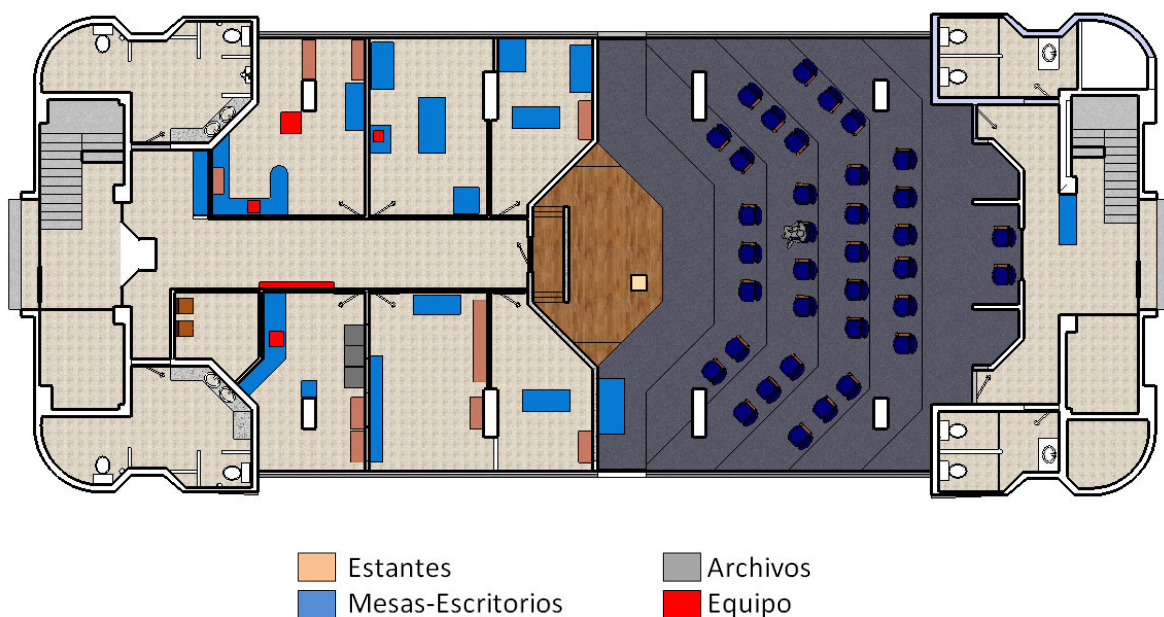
Ubicación de elementos no estructurales en la Biblioteca de Salud: Planta baja.
